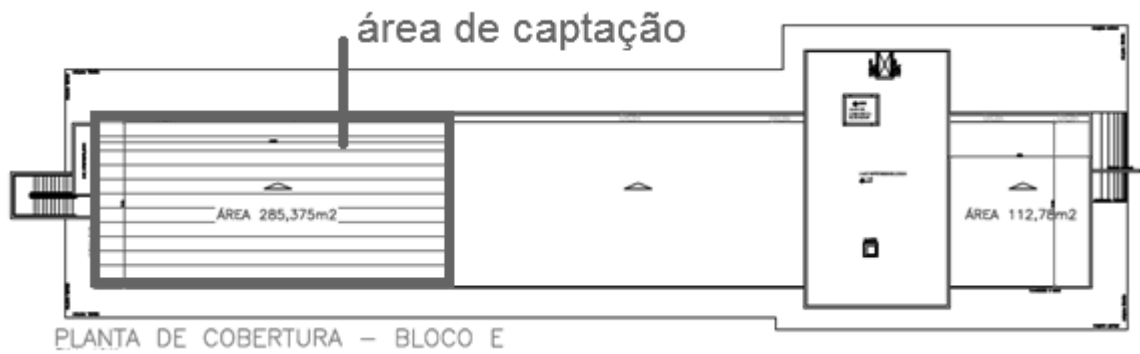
Área de captação das águas pluviais para armazenamento e posterior utilização.
